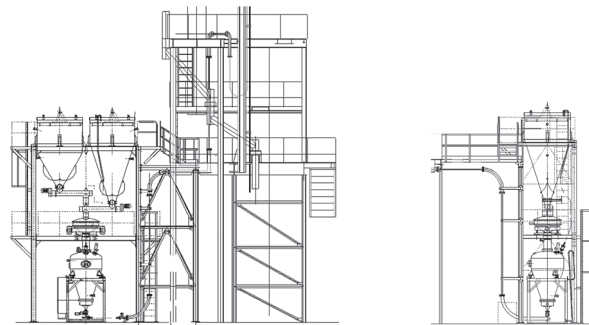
Конструкция пневмотранспортной установки для агрегата печь-ковш
